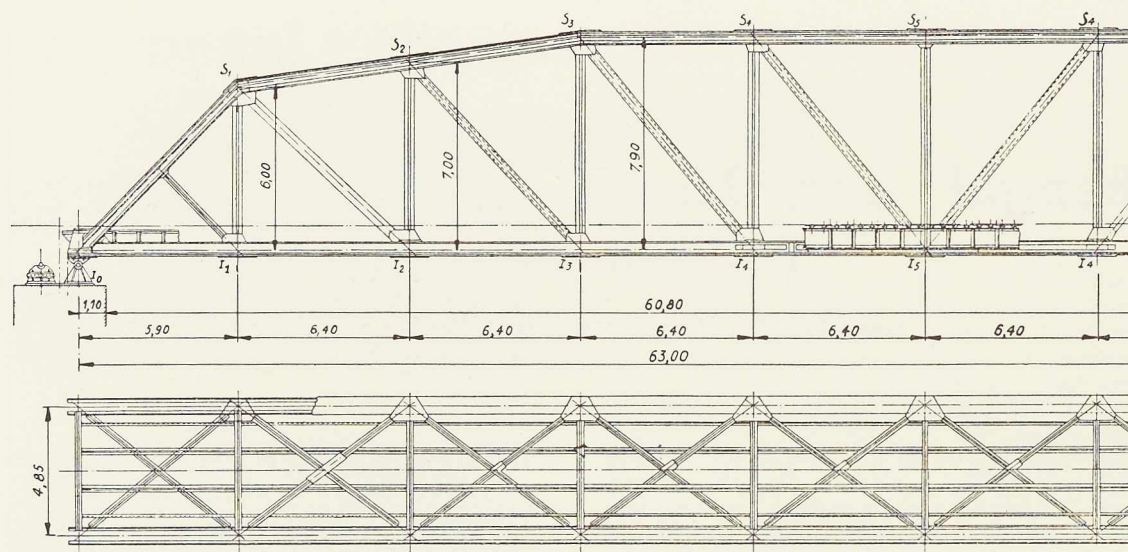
Elévation et vue en plan d'une demi-travée du pont.
